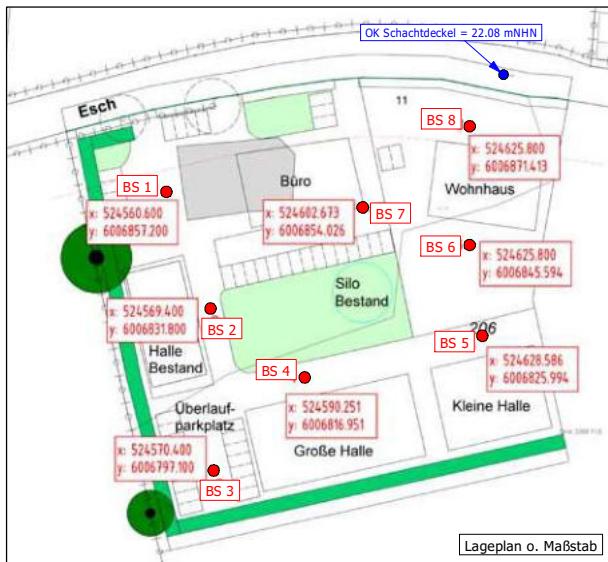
Ausschnitt Lageplan Anl. 1.1 (o. M.)
